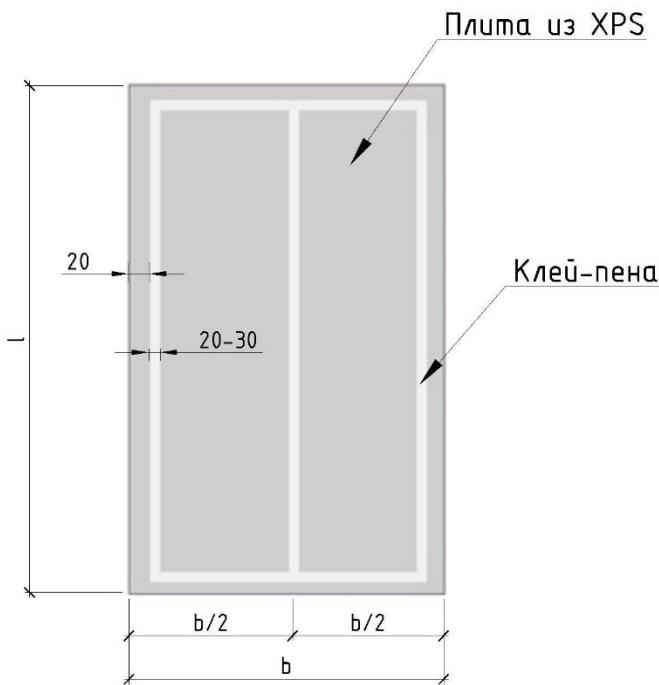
Схема нанесения клей-пены на теплоизоляционную плиту
